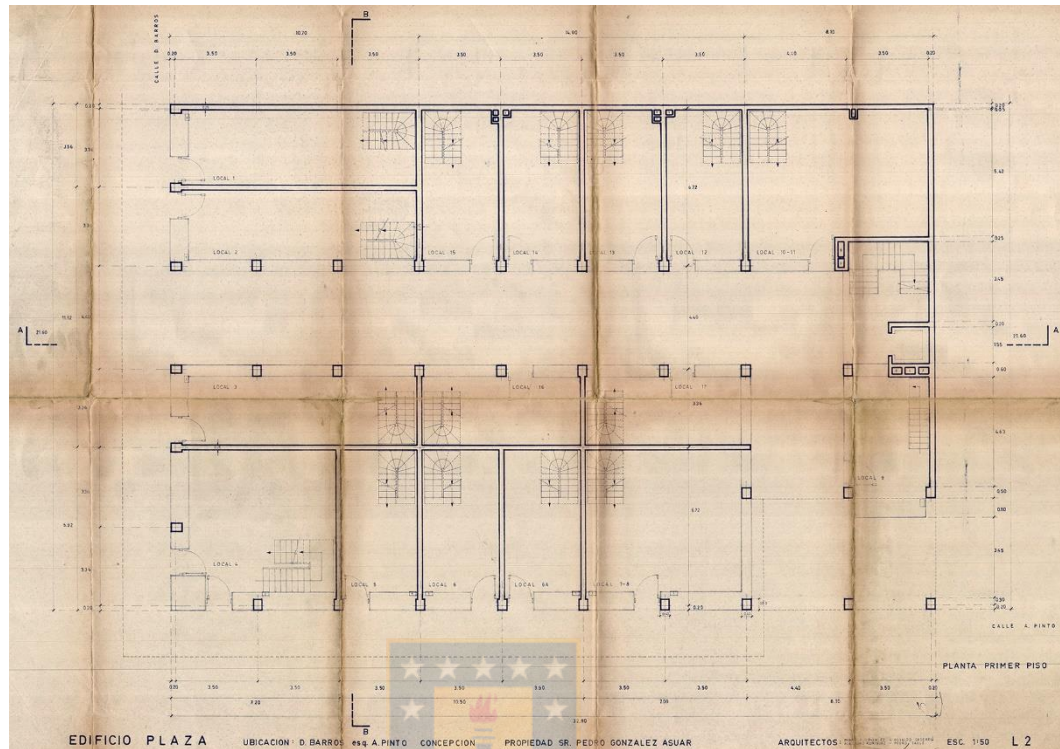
Planta de 1° piso y planta tipo torre. Edificio Plaza.
